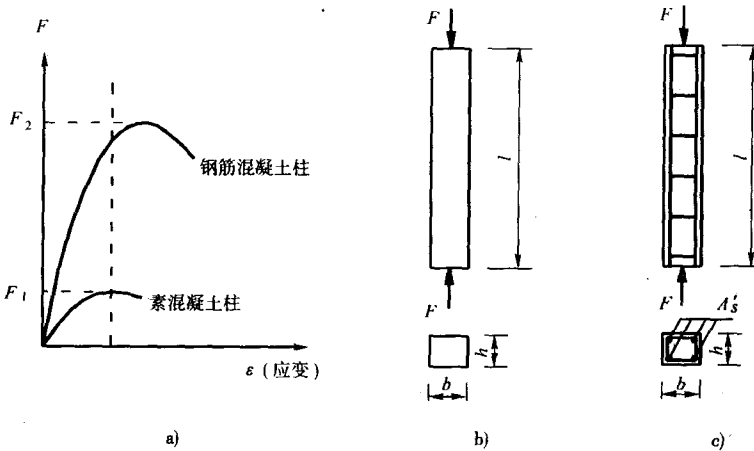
素混凝土和钢筋混凝土轴心受压构件的受力性能比较
